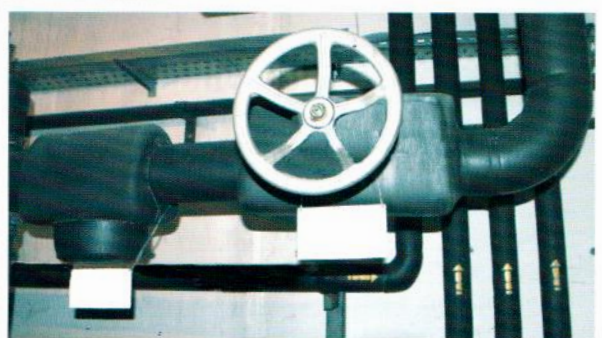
Внешний вид эксплуатируемого теплоизоляционного покрытия холодильных трубопроводов и запорно-регулирующей арматуры при выполнении требований СП 61.13330.2012 [2]
